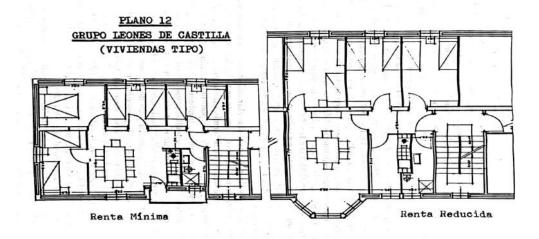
Plano de las viviendas del grupo Leones de Castilla. Fuente: Fernández (1991: 214).
